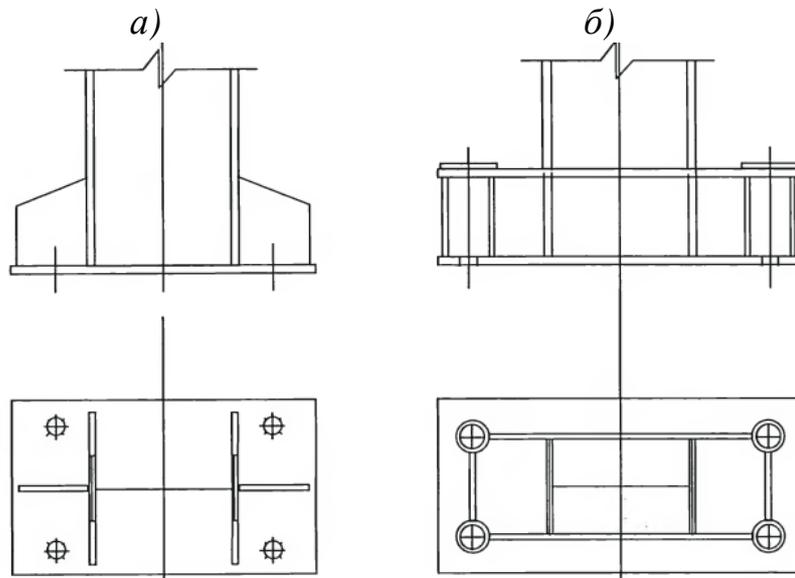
Конструкции баз стальных сплошных колонн с различной конструктивно-расчетной схемой опорного узла примыкания к фундаменту высотных зданий: а – с опорным листом, подкрепленным вертикальными ребрами (по шарнирной схеме); б – со сварной траверсой (по жесткой схеме)
